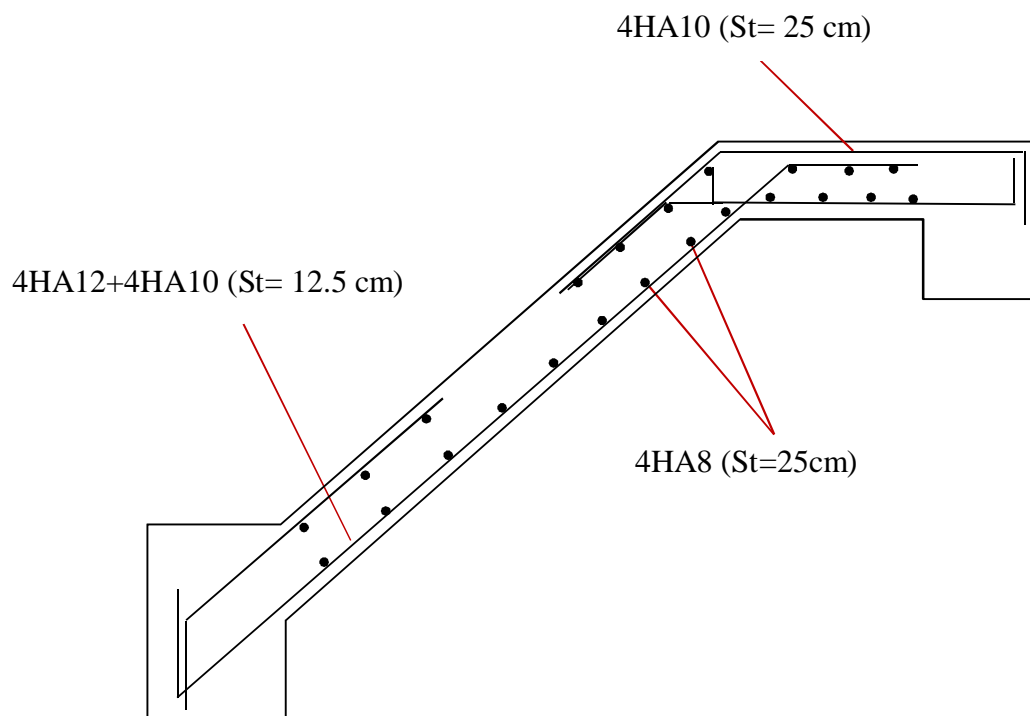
Schéma de ferrailage de l'escalier type 2(Service)
